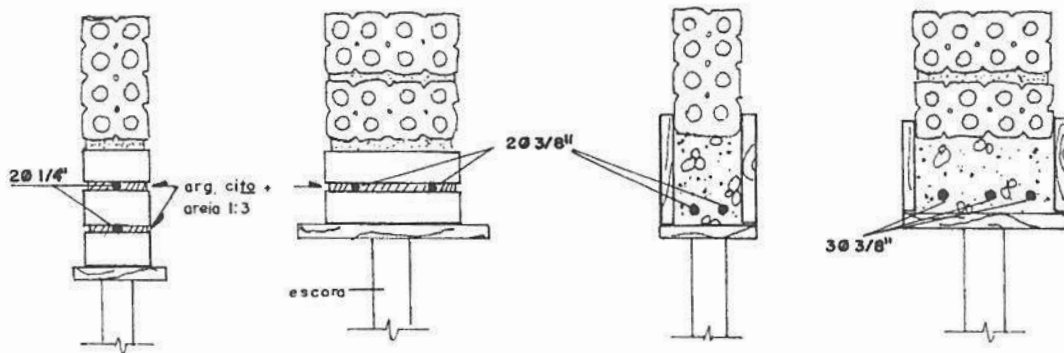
Vergas em alvenaria de tijolo furado para vãos até 1,00m e entre 1,00m e 2,00m.
